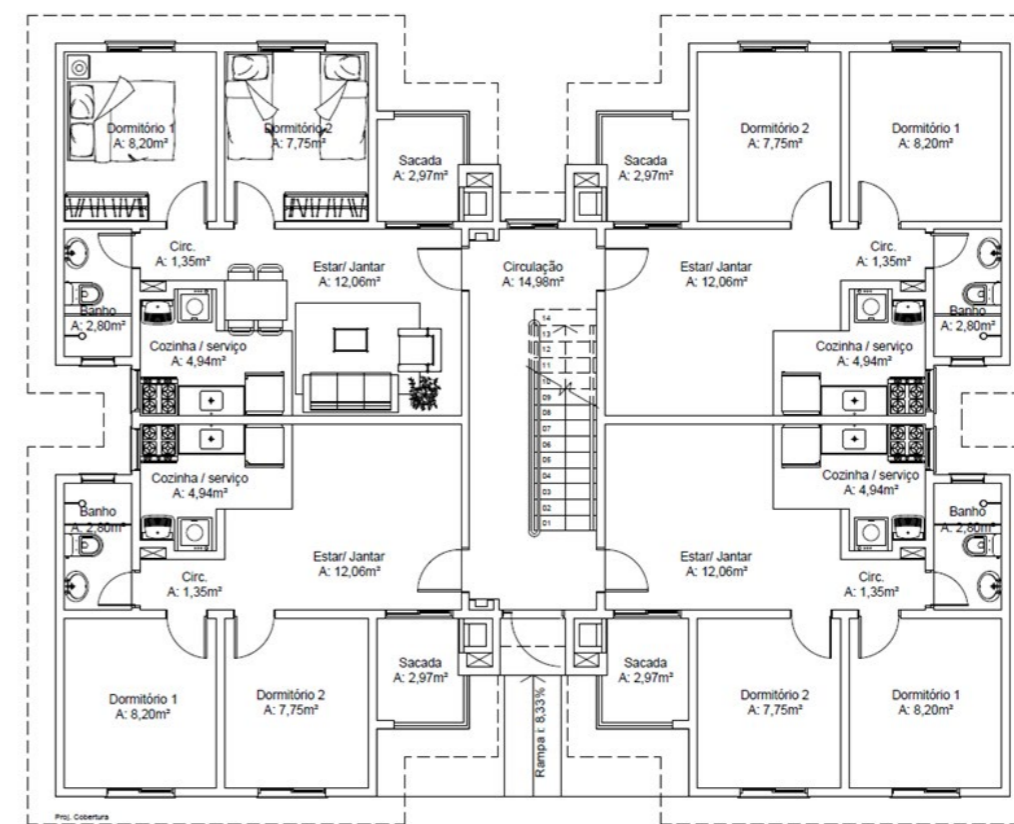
Planta baixa da edificação em estudo. Fonte: Morales *et al.* (2017).
